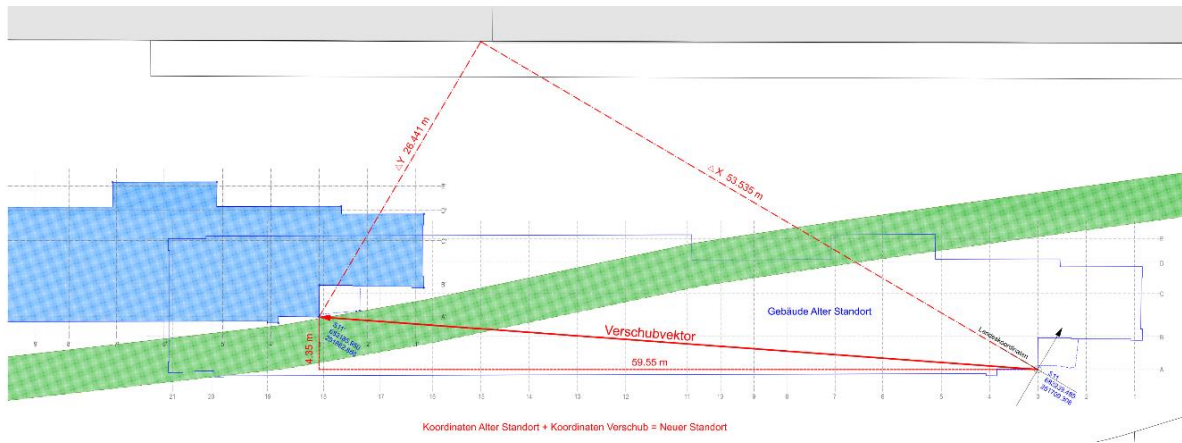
, plano de triangulación, calculo punto de desplazamiento
